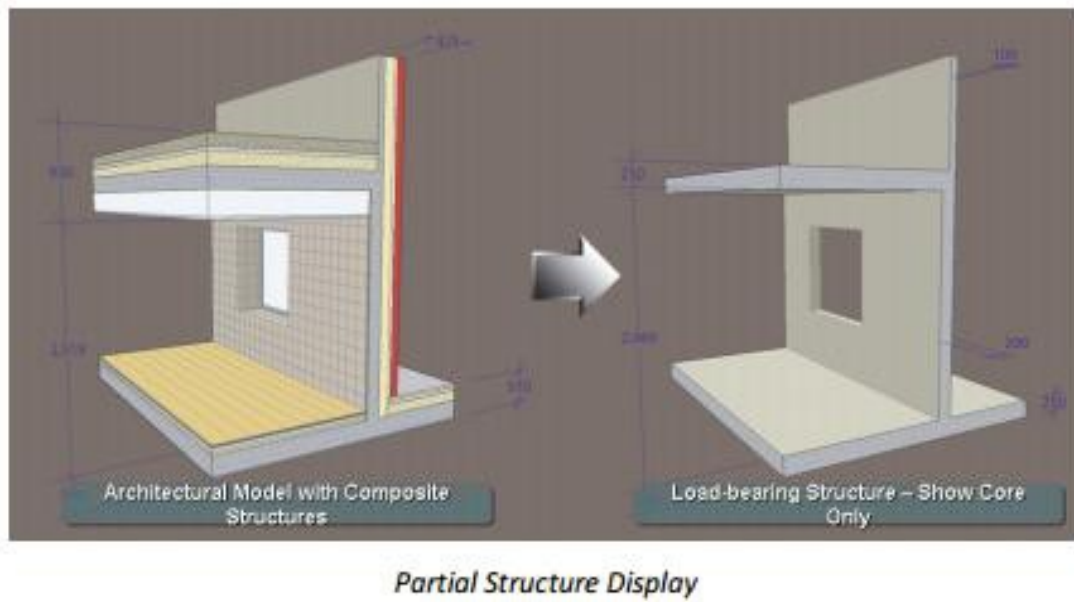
Vista de conversión de un modelo arquitectónico a modelo estructural utilizando la opción Partial Structure Display dentro del programa ArchiCAD®.
